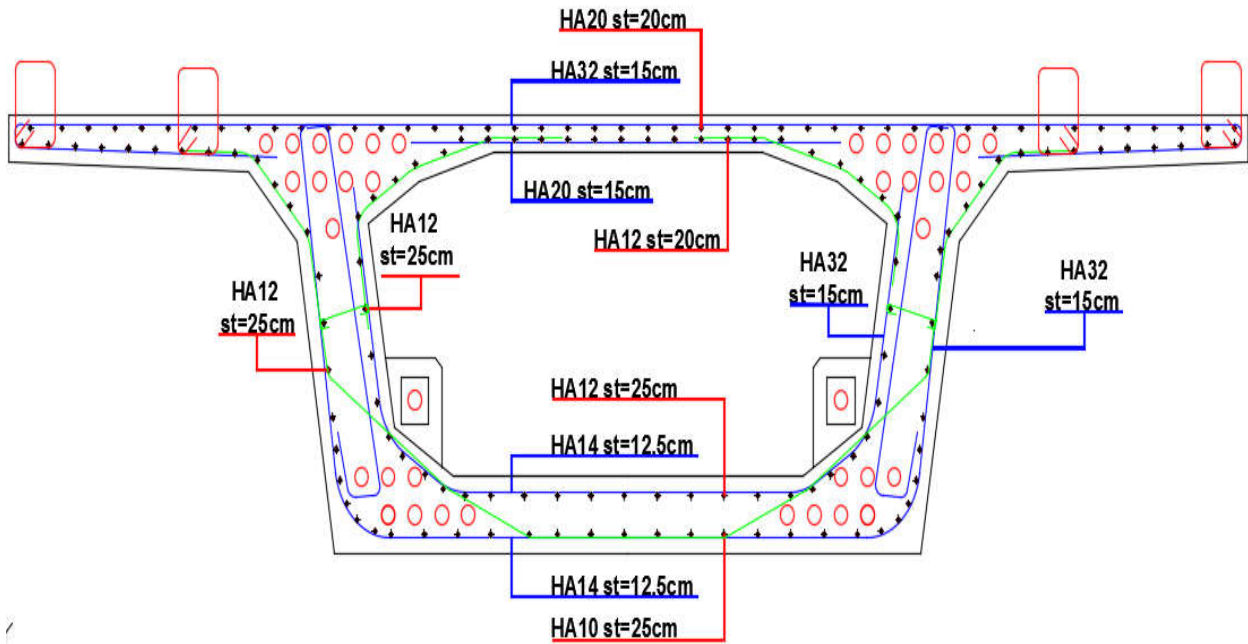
4. Schéma du ferrailage passif du voussoir courant.
